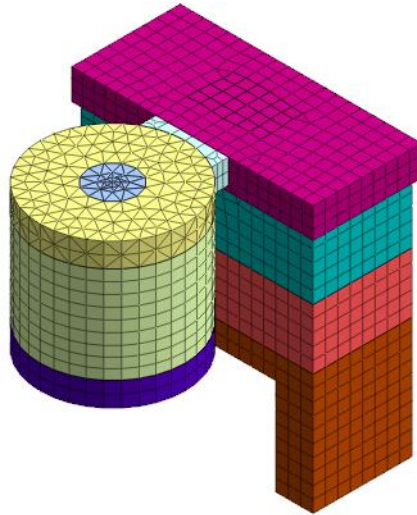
Geometria e mesh delle due fondazioni con il link di collegamento strutturale
